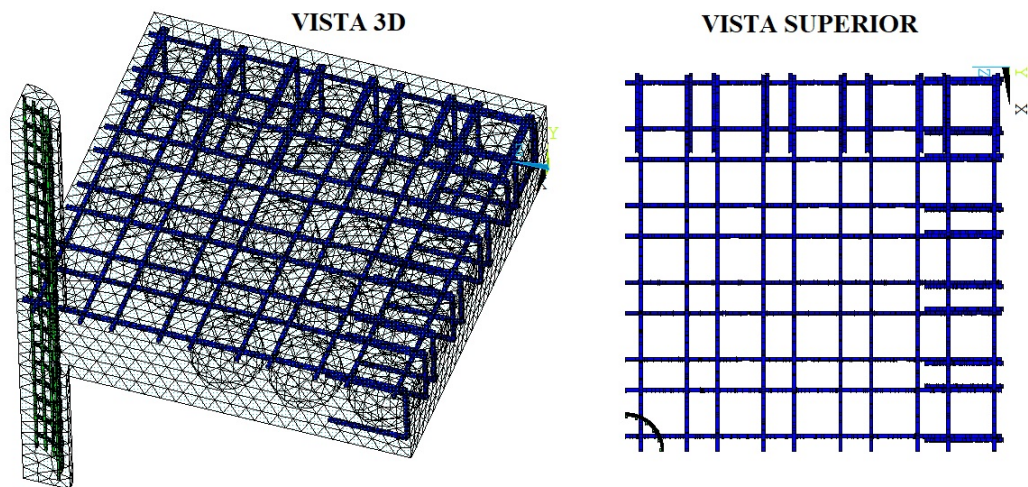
Modelagem da armadura de flexão e armadura do pilar
